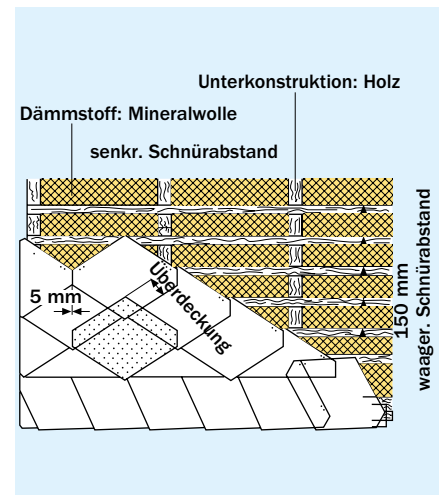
Holz-Unterkonstruktion, hier: Zweifachlattung mit kleinformatiger Bekleidung in Rhombus-Schablonen-Deckung
